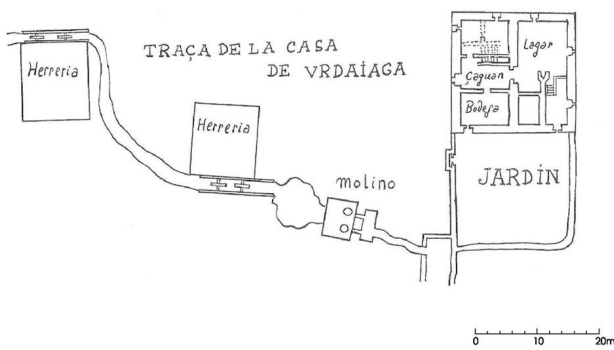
Planimetria histórica do conjunto edificado do Palácio Urdaiaga, século XVI. Casa Ducal de Híjar.
